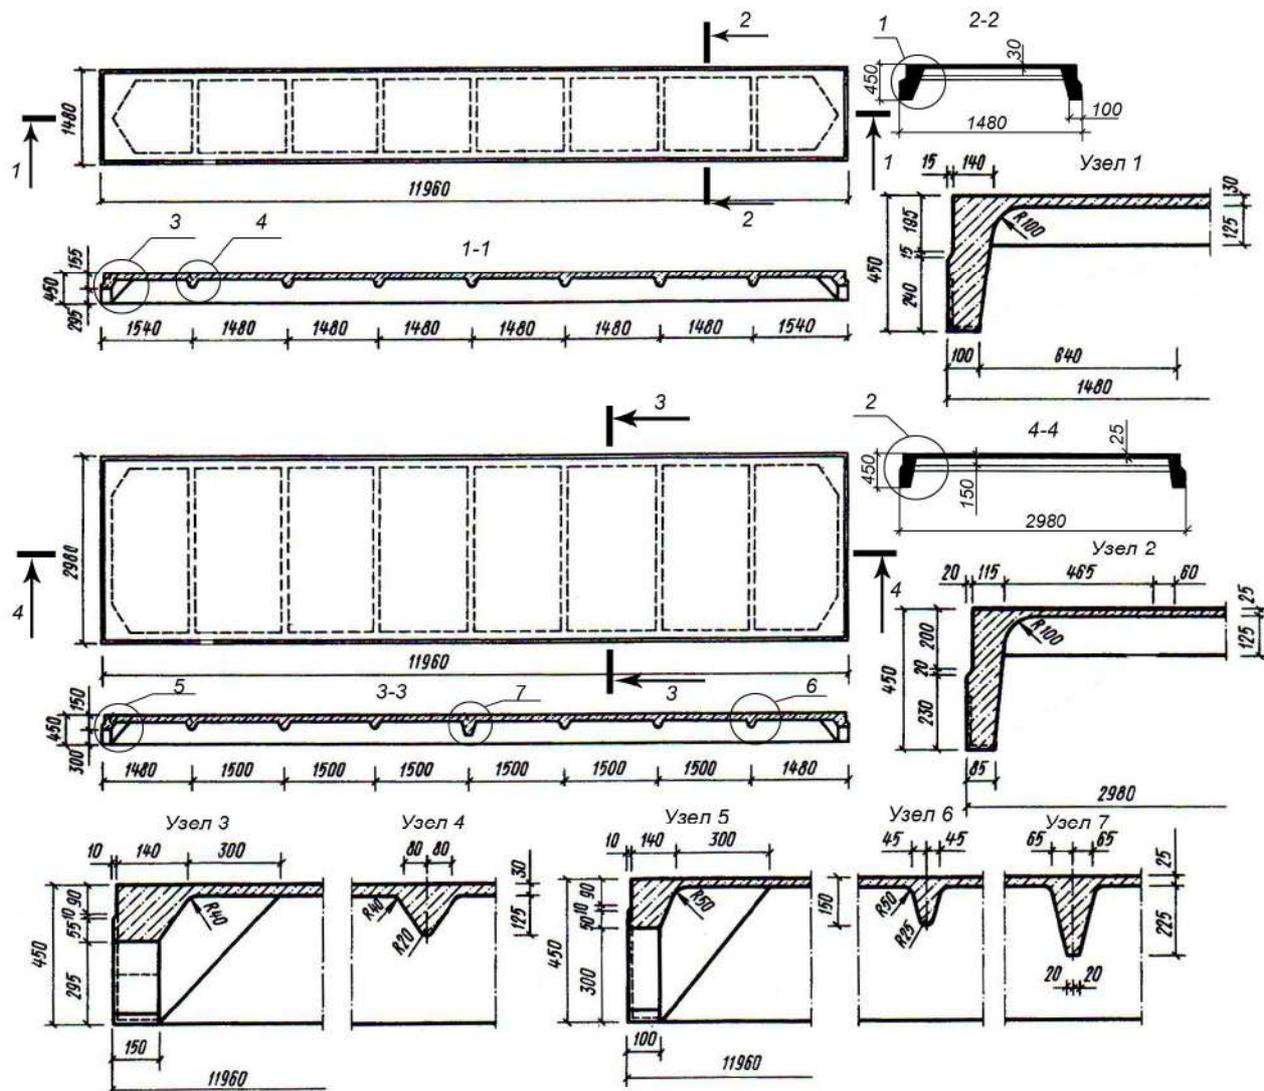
Плиты железобетонные ребристые размером 12,0 × 1,5м и 12,0 × 3,0м для покрытий производственных зданий
